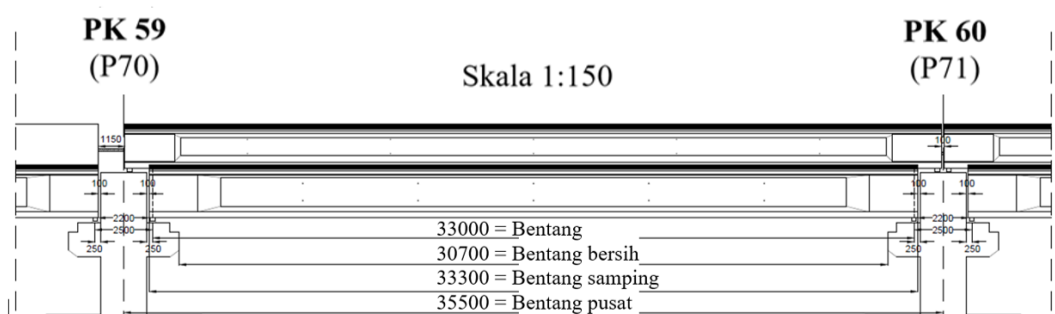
Tampak Atas Proyek Jembatan *PCI Girder* Jalur K.A Bandara YIA STA.5+082 S/D STA.5+346
